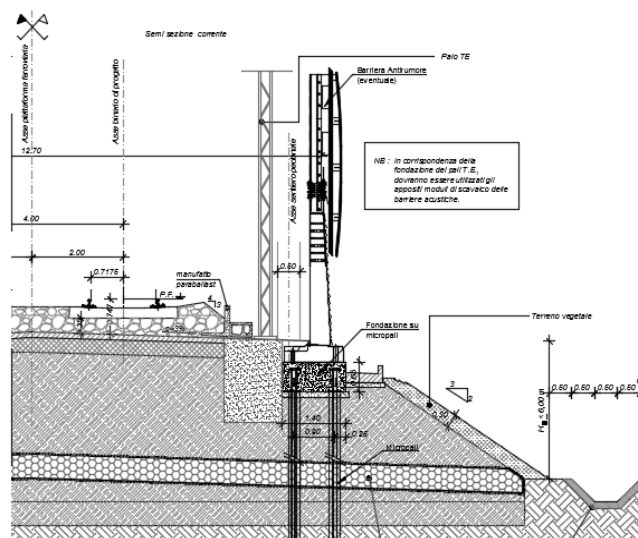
Stralcio sezione tipo in rilevato, con barriera antirumore standard rettificata
